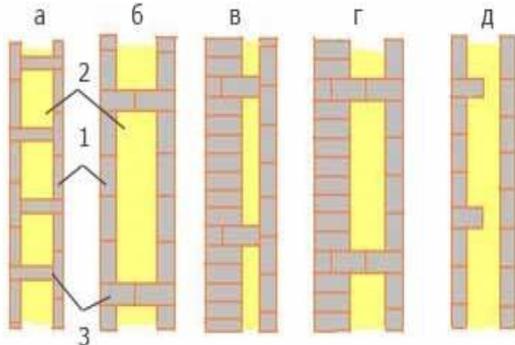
Возможные варианты колодцевой кладки стен из кирпича (вид сверху):
